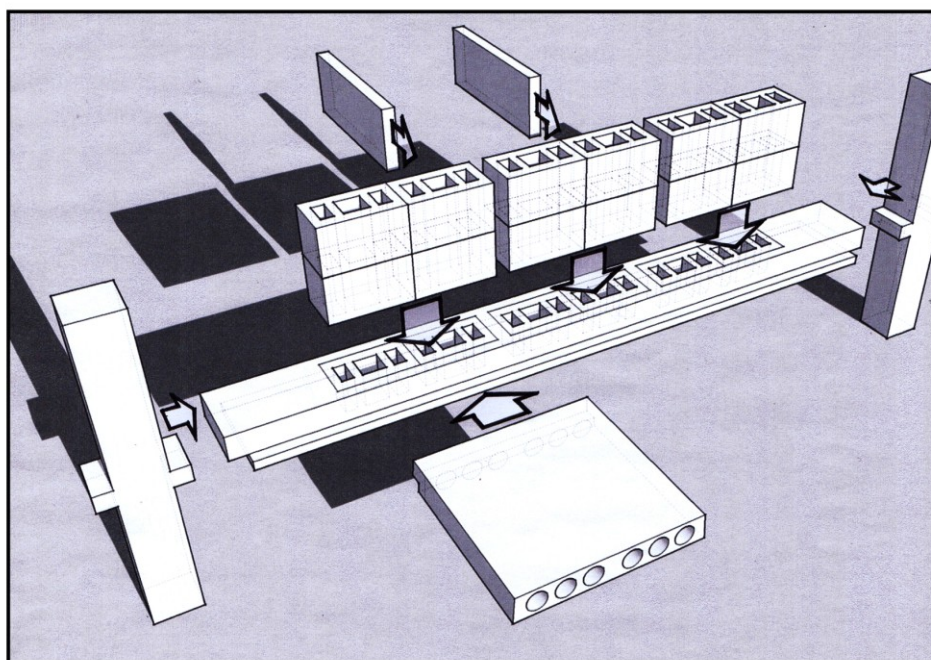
Универсальный ригель «Нуртамаг» с вентиляционными блоками из пенобетона.Взрыв - схема (Иллюстрация авторов).
